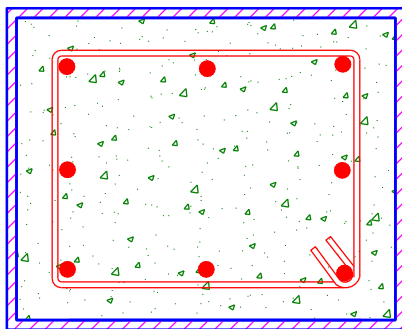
Sección de un miembro compuesto relleno con armadura longitudinal de refuerzo.
